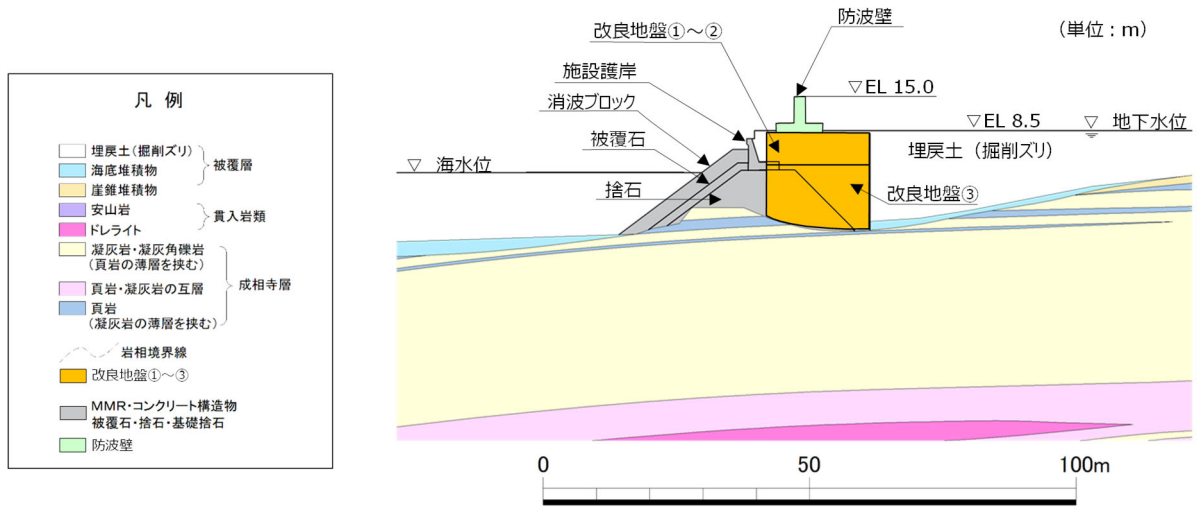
防波壁 (逆 T 擁壁) の横断面図 (⑤-⑤断面)
